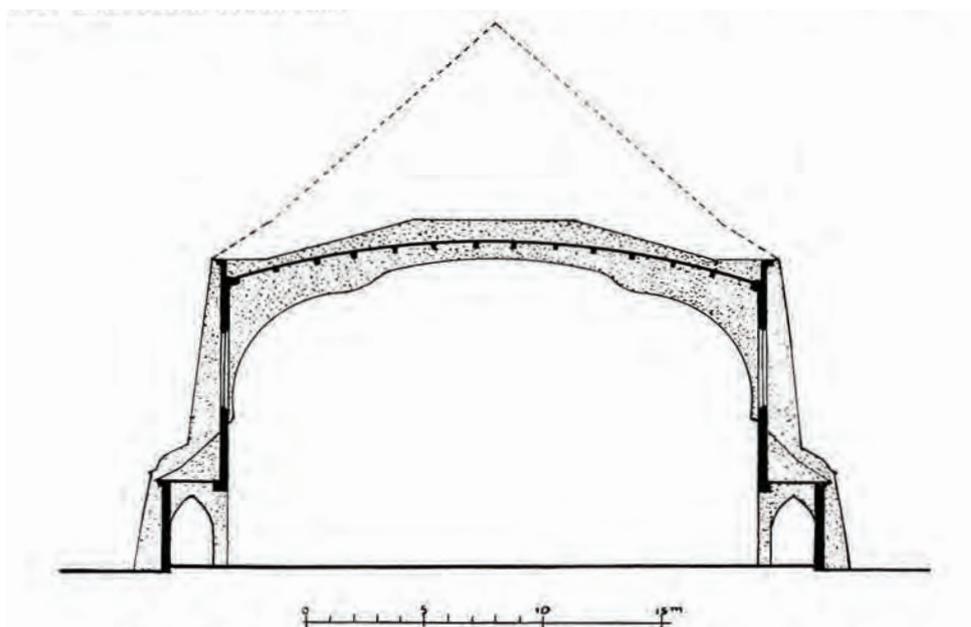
Verbindung eines Eisenbeton-Binders mit Backsteinmauerwerk an der Garnisonkirche in Ulm.
